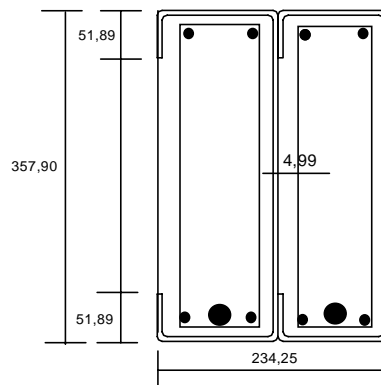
Seção Transversal da Viga VD2 (dimensões em mm)
